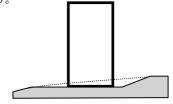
筑台布置示意图(图片来源: 作者自绘) Fig. 10 Schematic diagram of building layout
